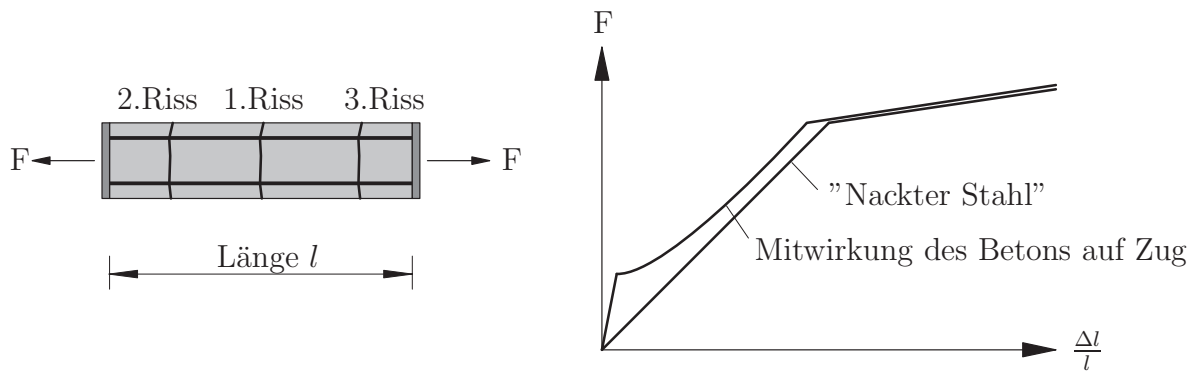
Tension-stiffening bei einem Stahlbetonzugstab
